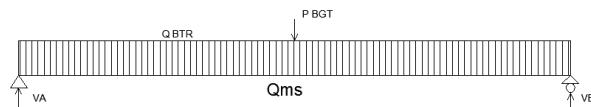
15 Permodelan Beban Mati Girder Tengah Bentang 23M
